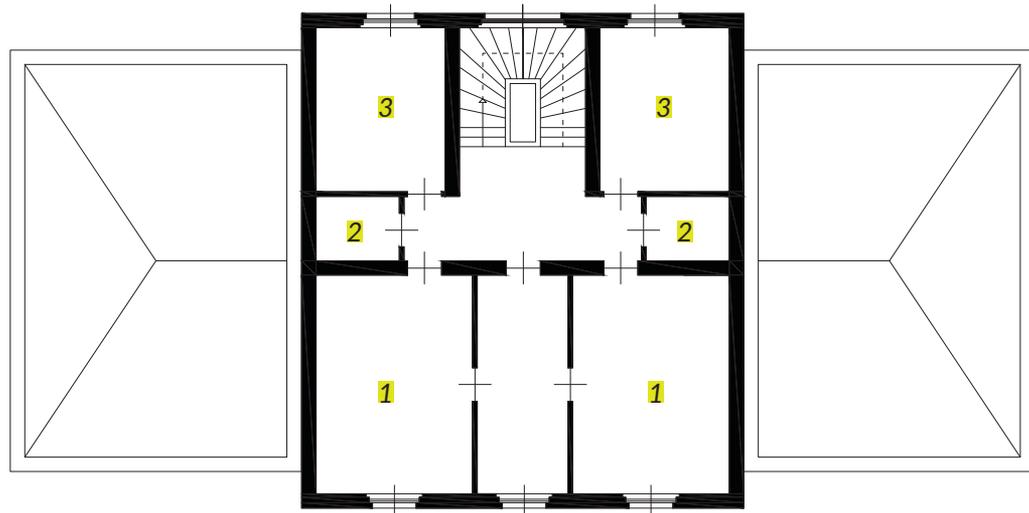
Verwaltungsgebäude Grundriss M 1: 200 (Stand 1885)
